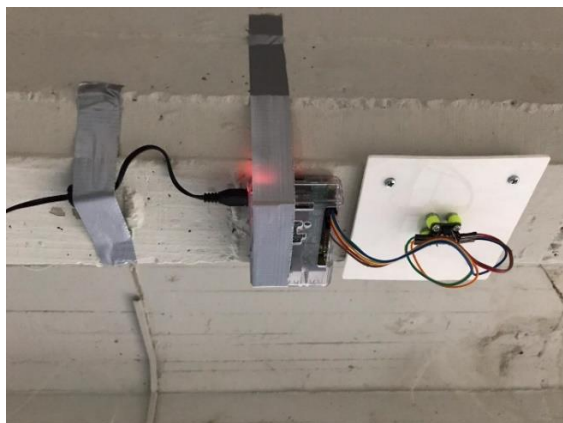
Configuración de instrumentación de los ensayos de vibración. Vista en planta de la losa N+8.25m (Ortiz et al., 2020)
